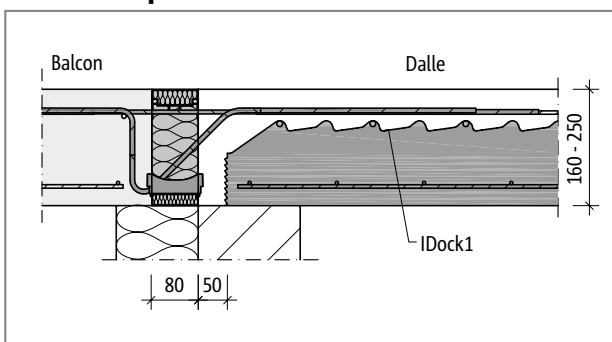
Schöck Isokorb® T Type K-E : Raccordement de balcons avec des épaisseurs de panneaux de 160 mm à 250 mm avec IDock1
